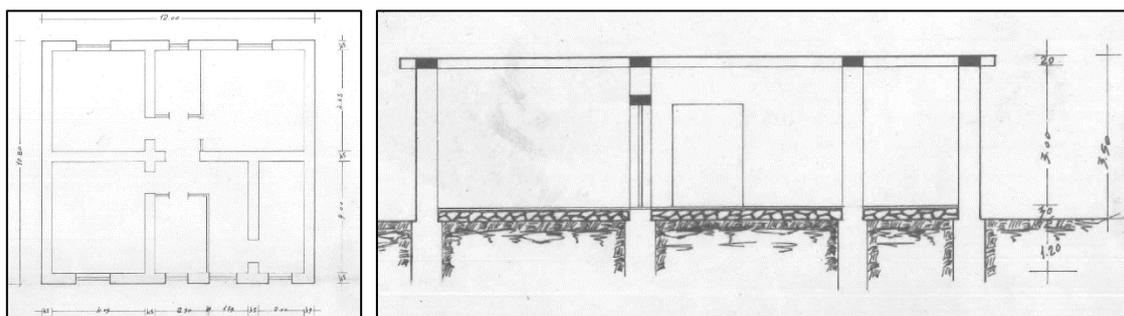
Pianta e sezione di un fabbricato tipo della tipologia MUR2
